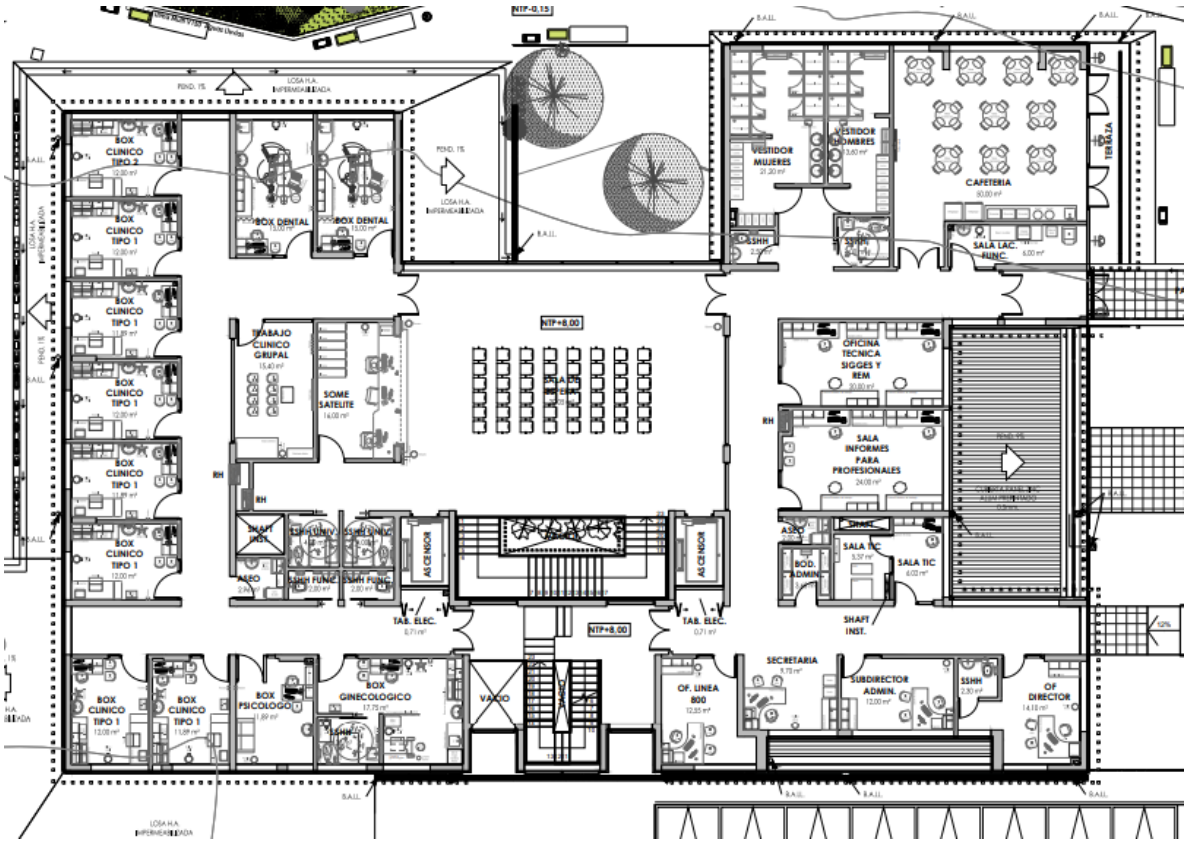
Planta de Tercer Nivel – Enero 2022
